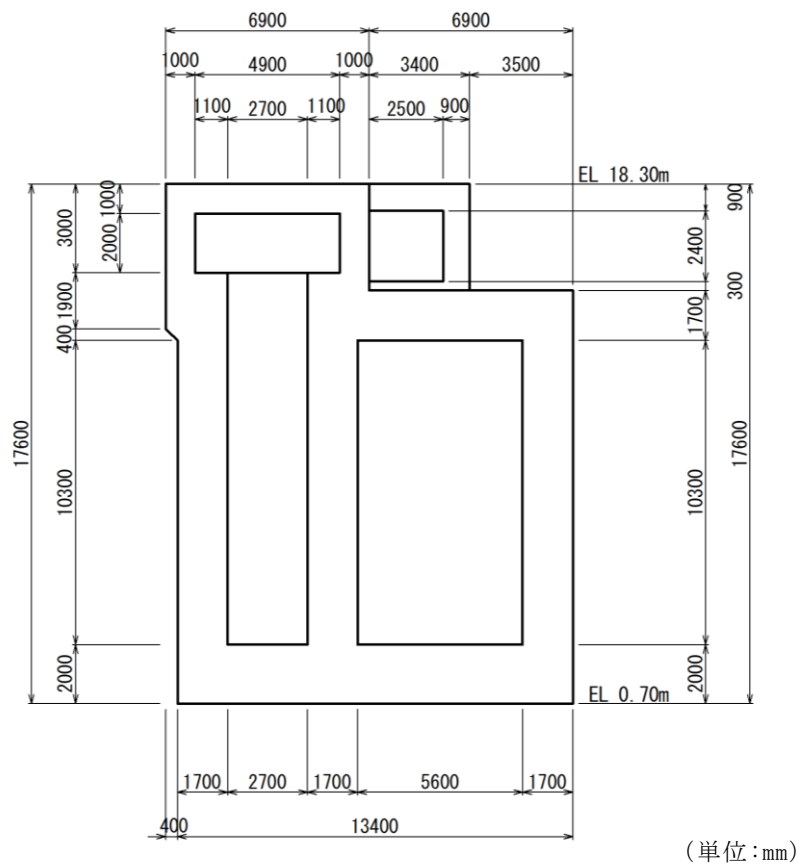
第 1 ベントフィルタ格納槽 断面図 (E-E 断面)
